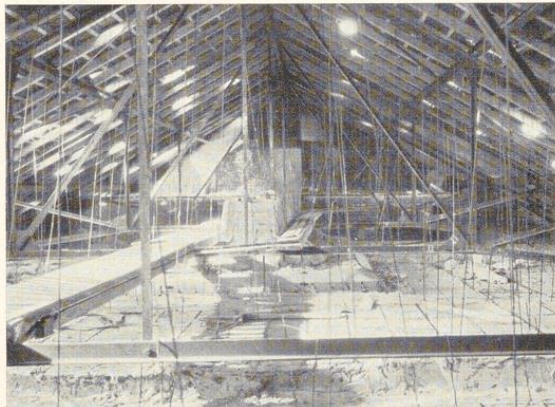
Abhängung einer Rabitzdecke an den hölzernen Sparren des Daches; dies erfordert sehr lange Abhänger
